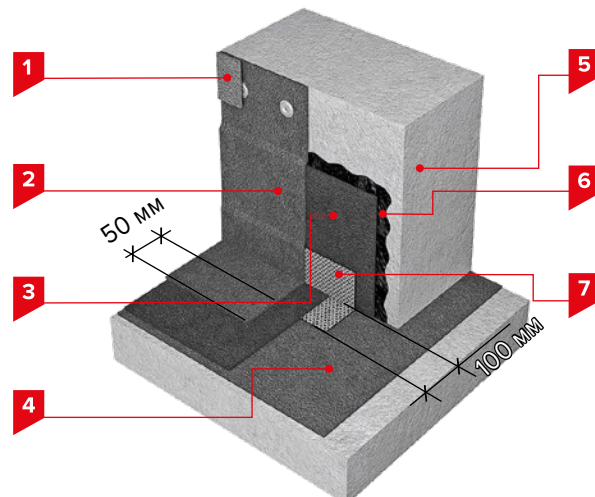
Техноэласт Фундамент TERRA с механической фиксацией. Обустройство внутреннего угла без применения галтели в зоне подошвы фундамента:
